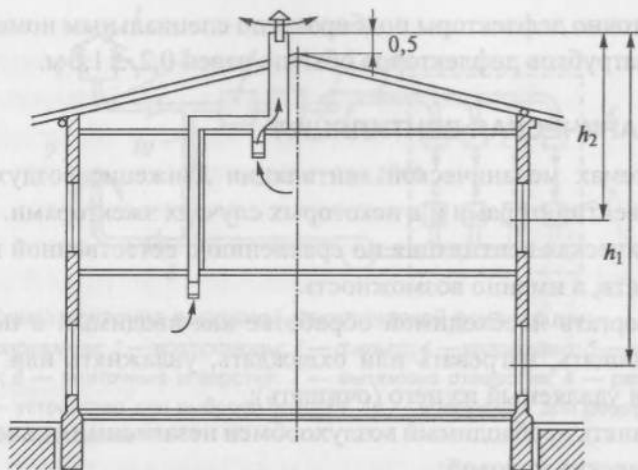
Схема естественной канальной вытяжной вентиляции:
